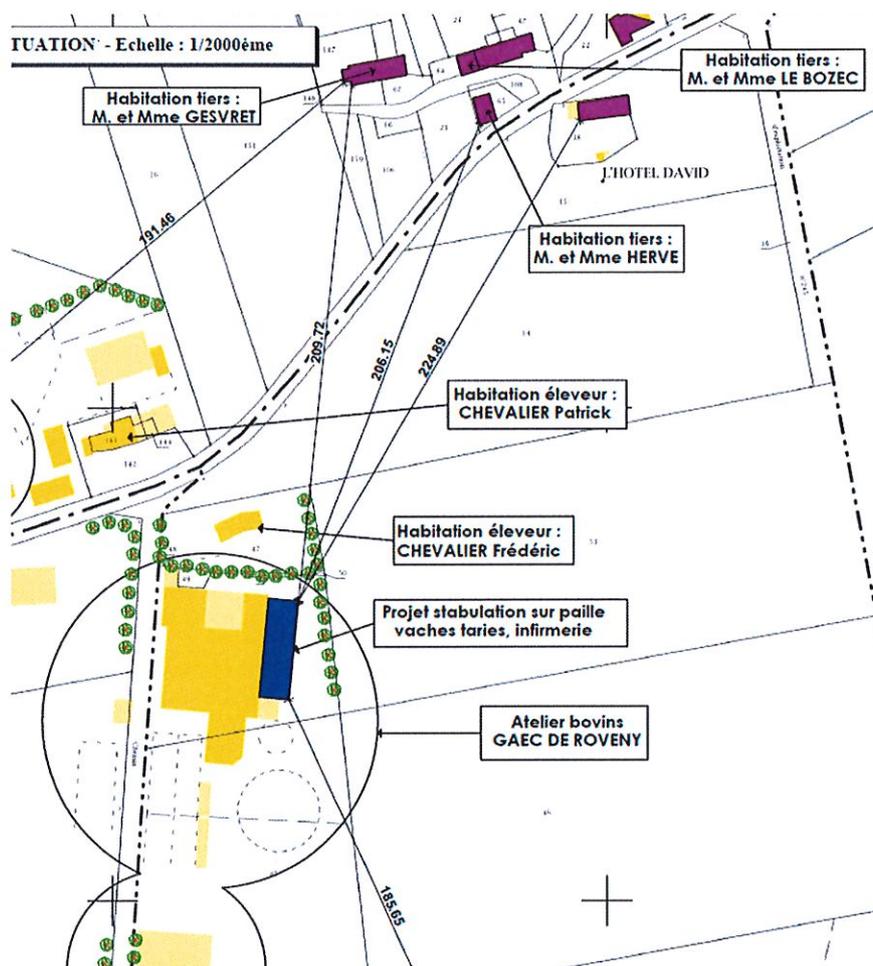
plan de situation à échelle réduite site du pâtis de la veille MONTERFIL
